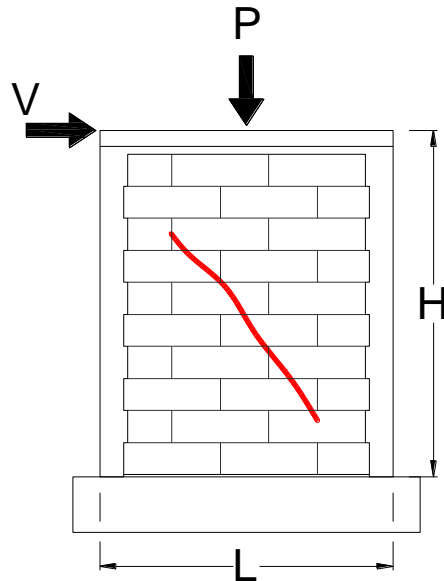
Grieta de cortante en un muro confinado
